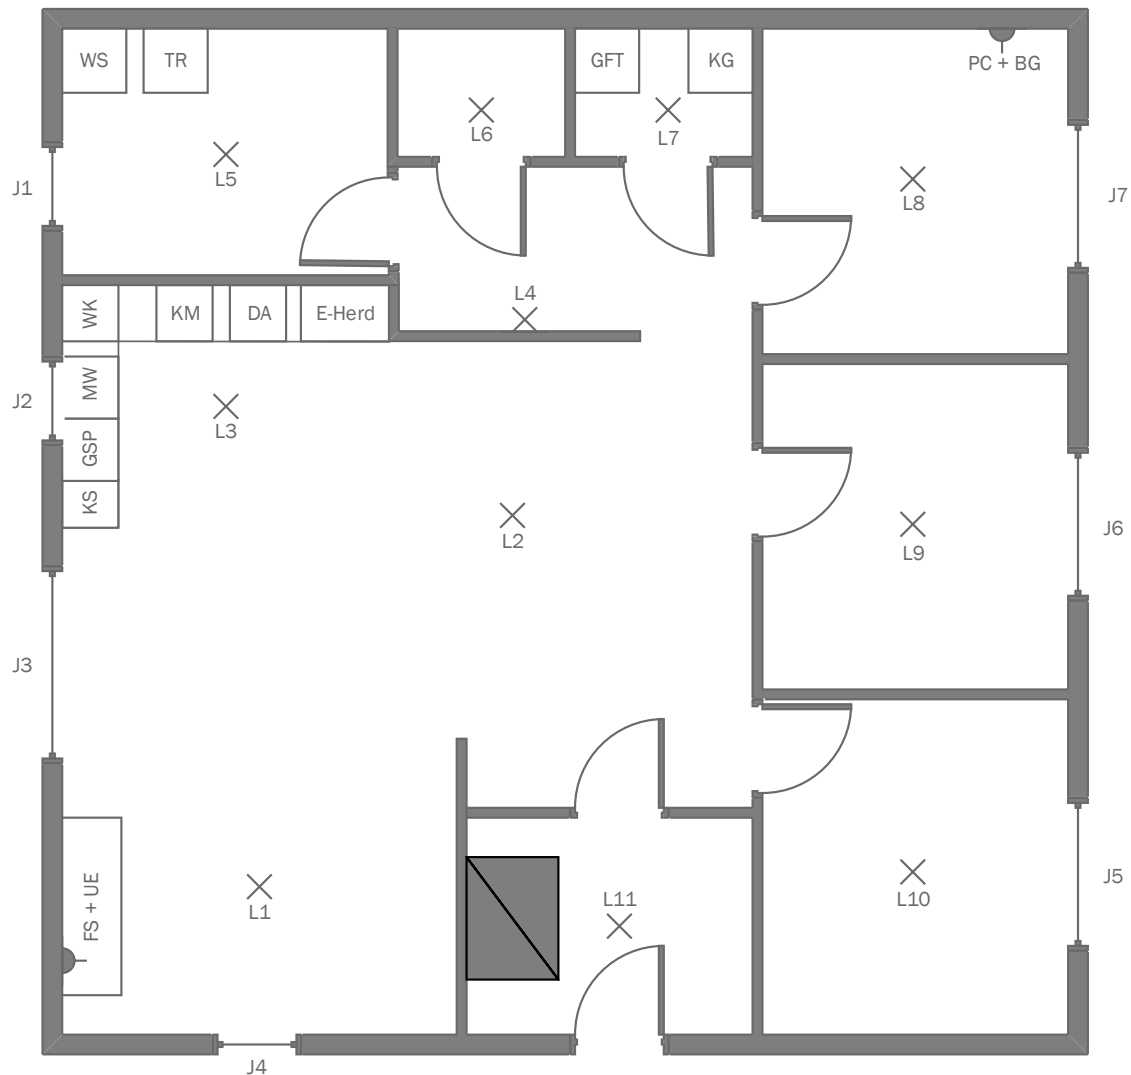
Grundriss des modellierten Hausnetzes
